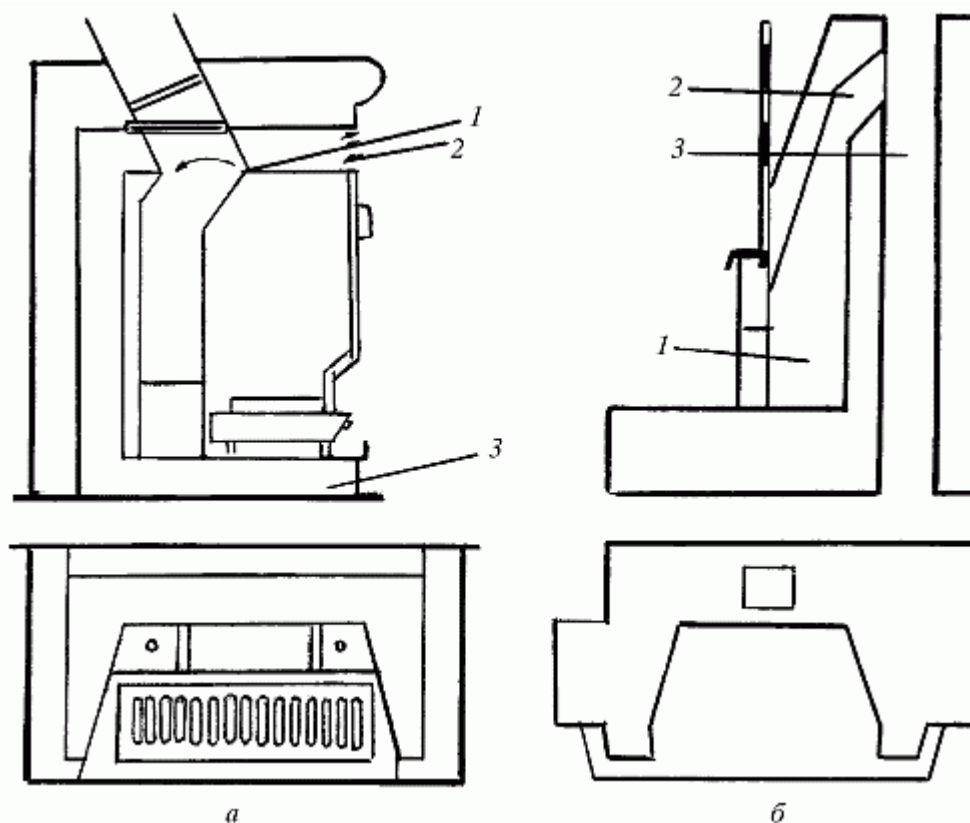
Каминь с боковым расположением дьмового канала: а – угольный: 1 – перекидной клапан; 2 – выход нагретого воздуха; 3 – вход холодного воздуха; б – дровяной: 1 – камин; 2 – соединительный газоход; 3 – дьмоход
